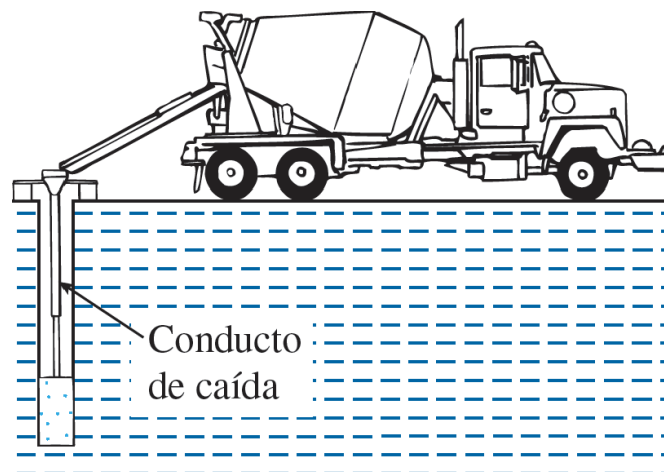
Conducto de caída para concreto (Das, 2012).
